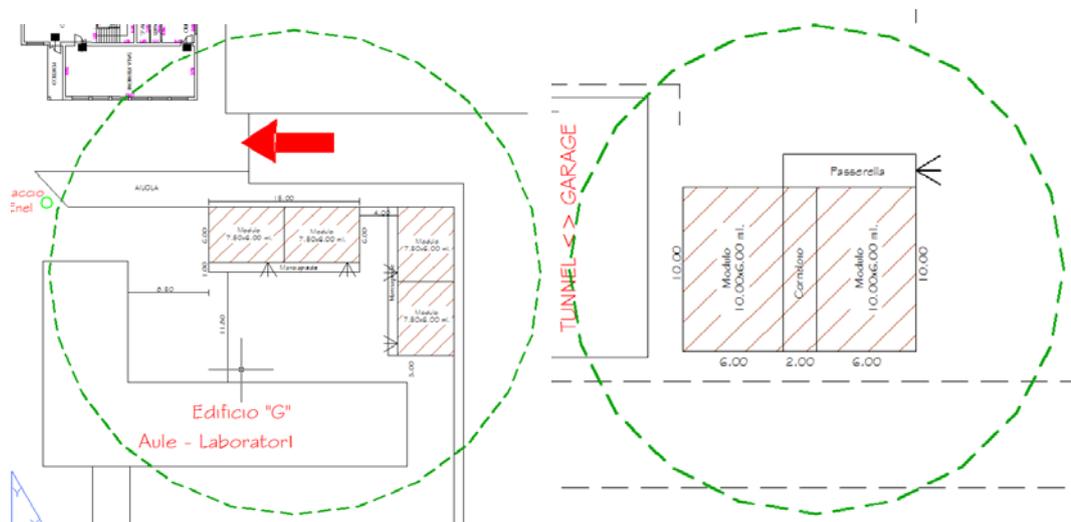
planimetria con disposizione dei lotti da 4x45m<sup>2</sup> e 2x60m<sup>2</sup>
